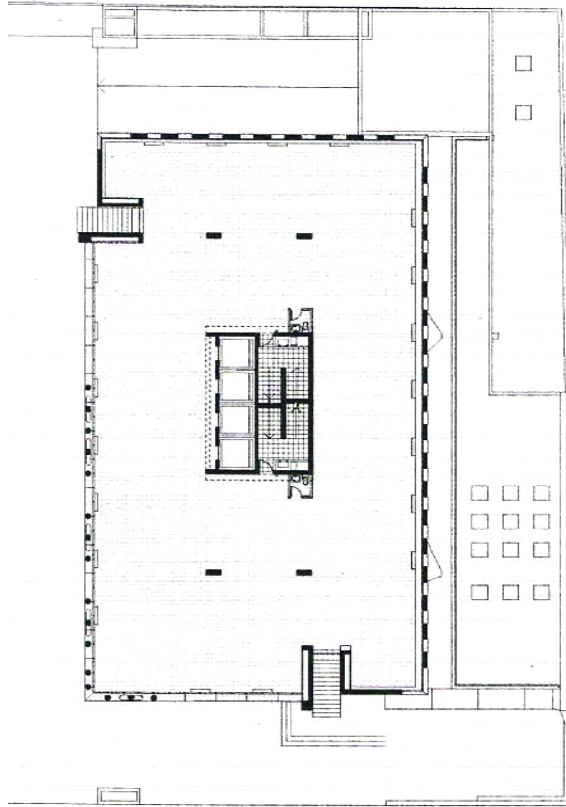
Manantiales Binası (-1). kat planı (Tasarım 143, 2004)
